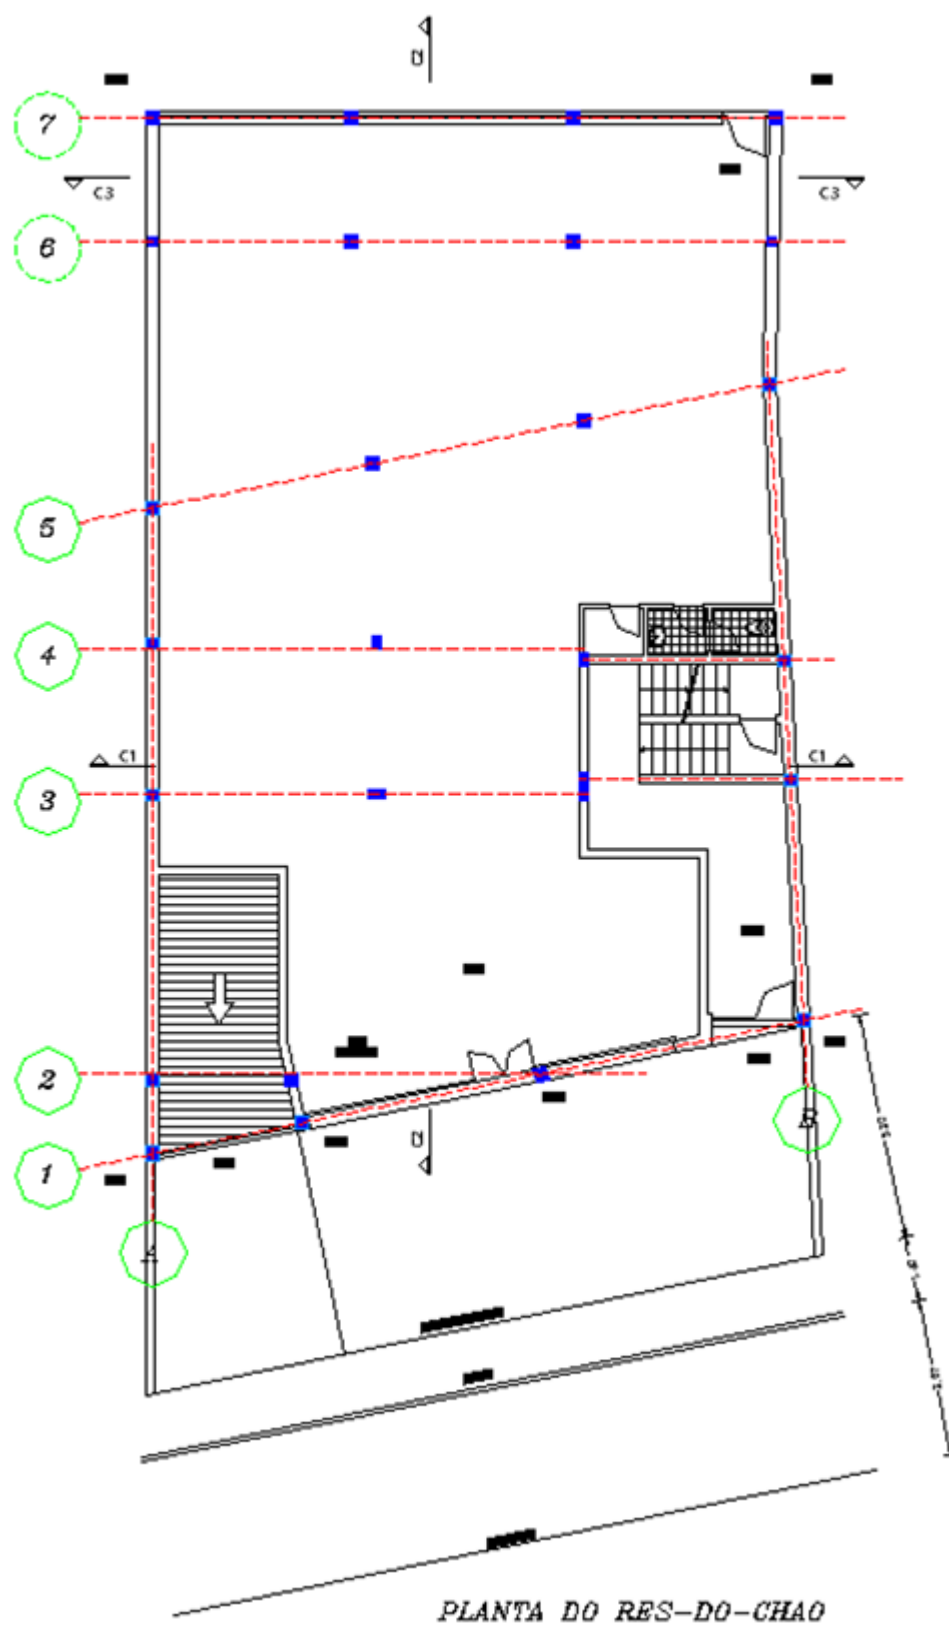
Solução estrutura adotada na planta da rés do chão (sem escala)
